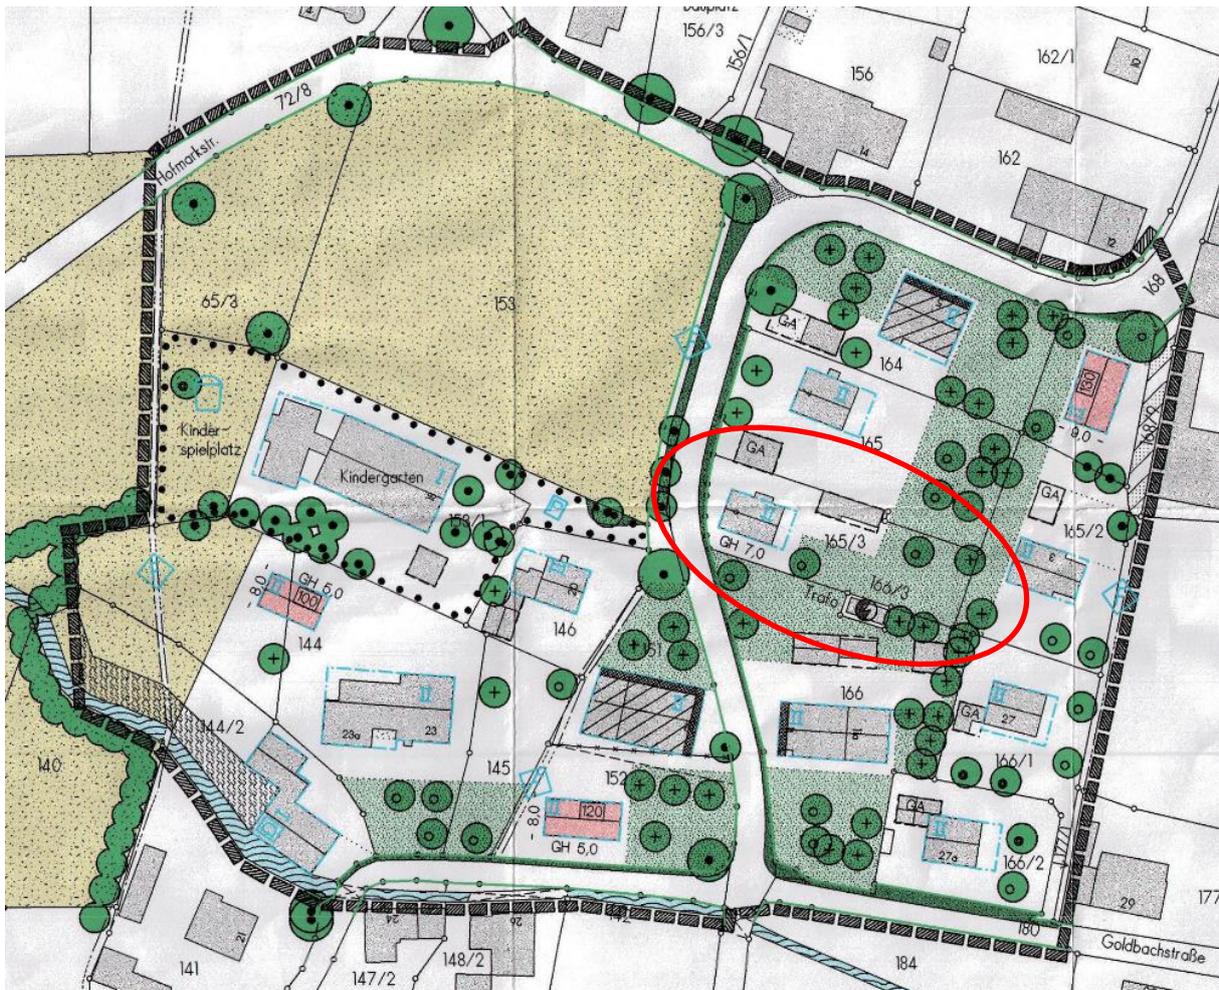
Auszug aus Bebauungsplan Nr. 77 „Neuburgstraße“, Datum des Inkrafttretens 05.05.2000 (schematisch rot umrandet) - ohne Maßstab
